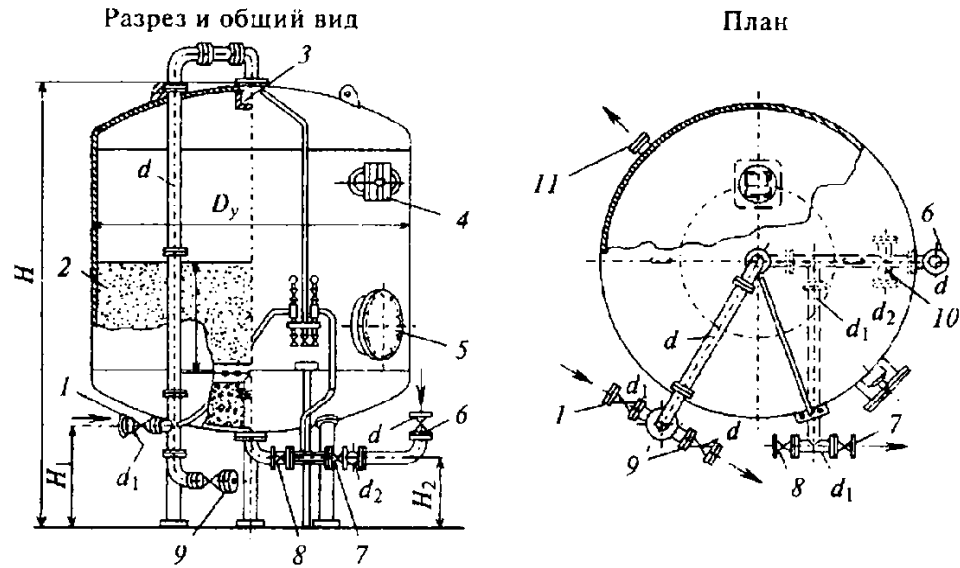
Напорный вертикальный фильтр с зернистой загрузкой:
